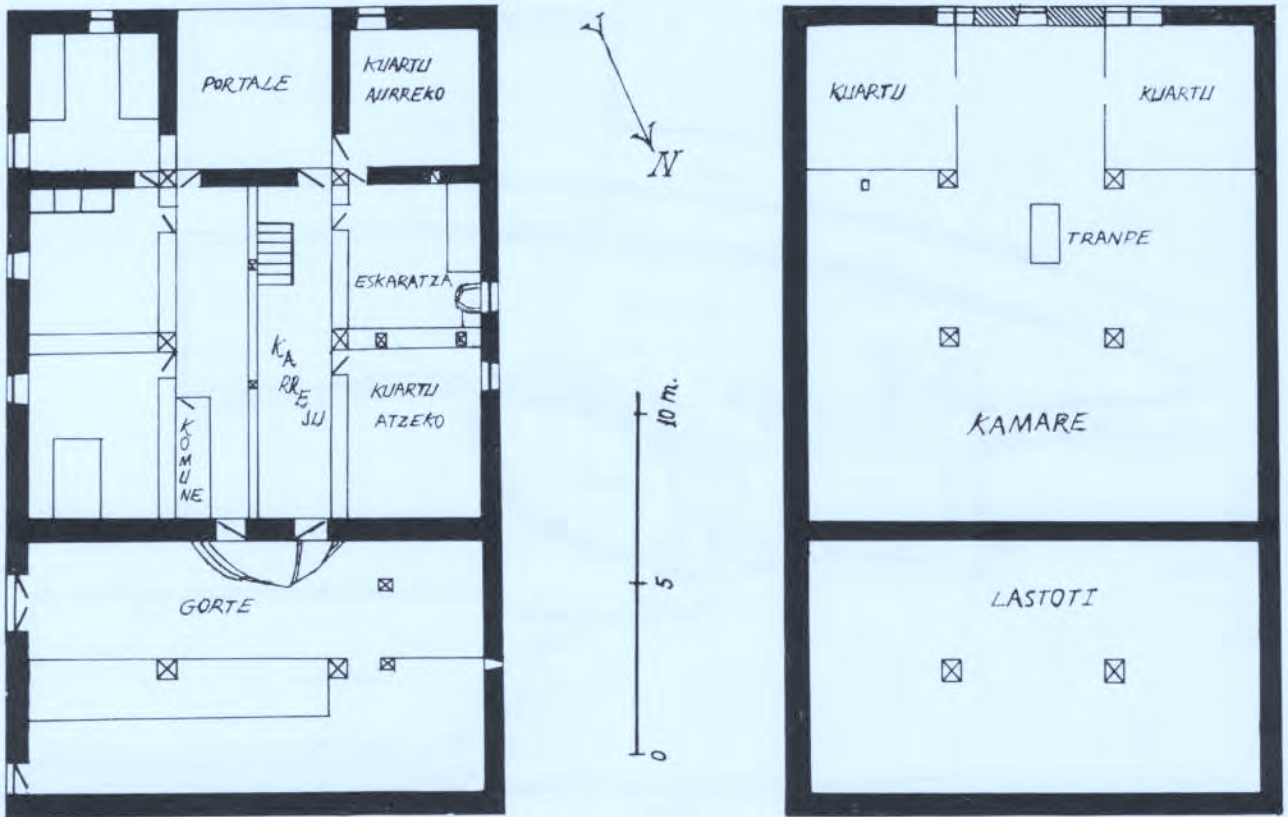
Croquis de planta baja y piso de Sigarrene.
